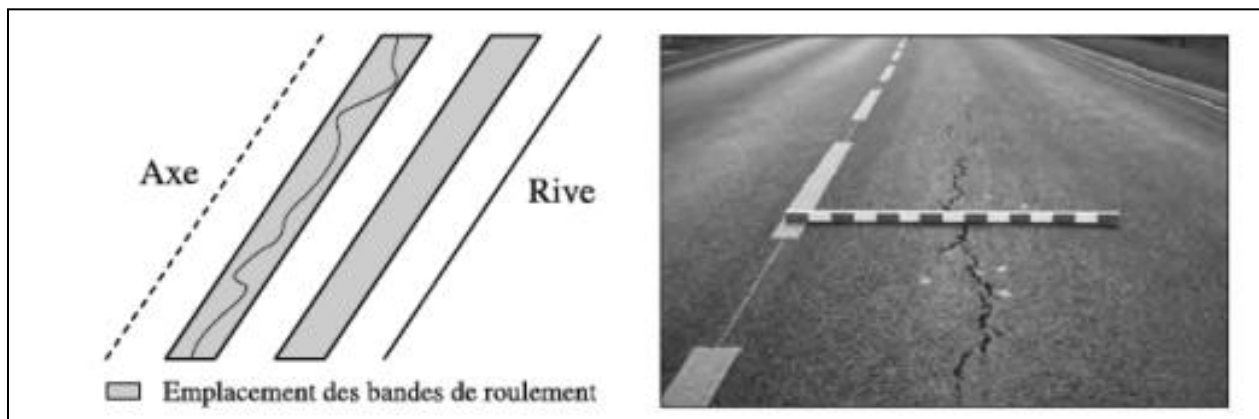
Schéma d'une fissuration longitudinale dans les bandes de roulement et exemple d'une fissuration grave ramifiée avec départ de matériaux [Di Benedetto et Corté 2005]
